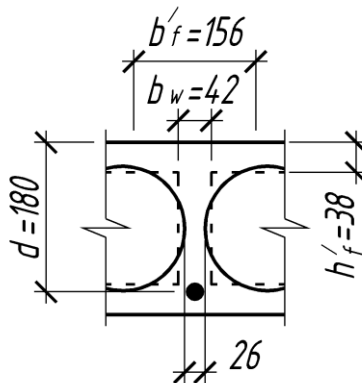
Ширина сжатой полки, учитываемая в расчете
